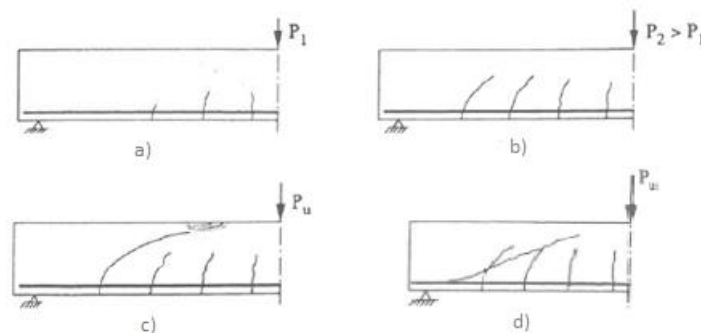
Proceso de fisuración de una viga de hormigón reforzado, simplemente apoyada y sometida a flexión
